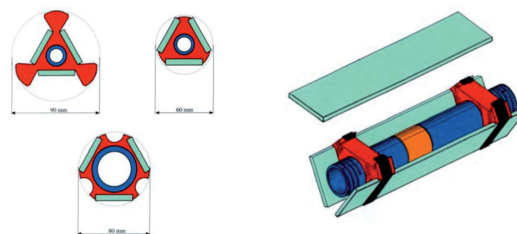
Elementi di fibra di vetro utilizzati per il consolidamento del fronte nel metodo di scavo a piena sezione. *Flat fiber-glass structural elements adopted for face reinforcement in the full-face excavation/construction method.
